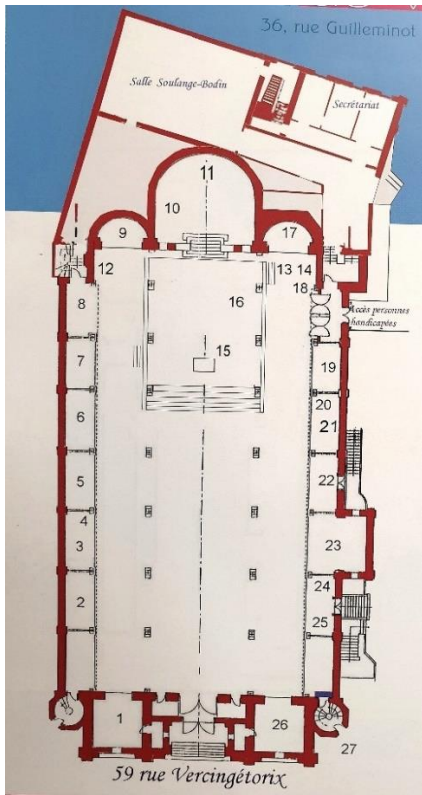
Grundriss <sup>[24]</sup> und
